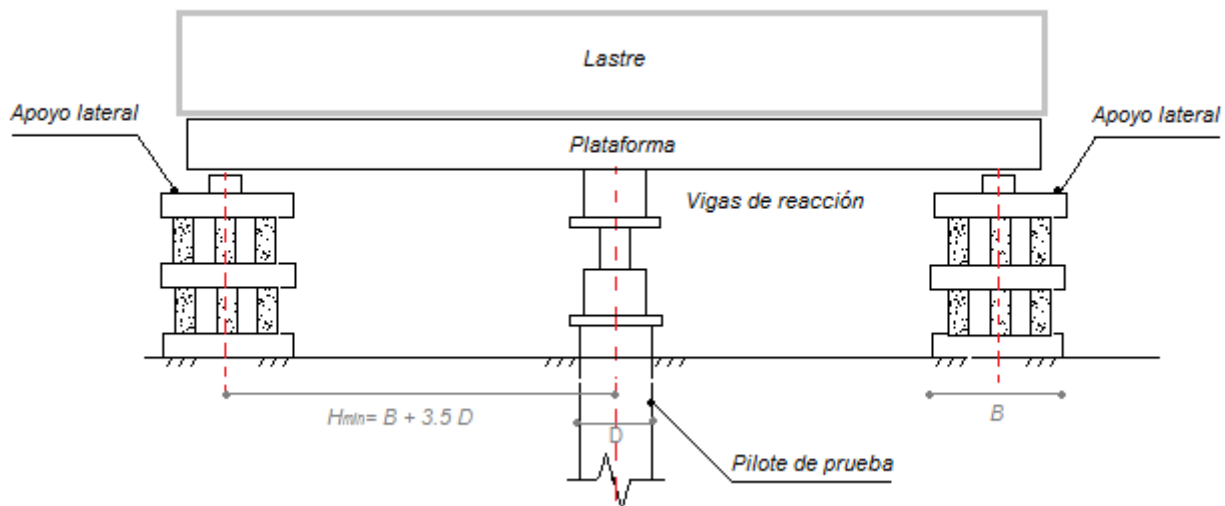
Plataforma con lastre, Manual de Diseño y Construcción de Pilas y Pilotes, Modificado de SMIG 1983.
